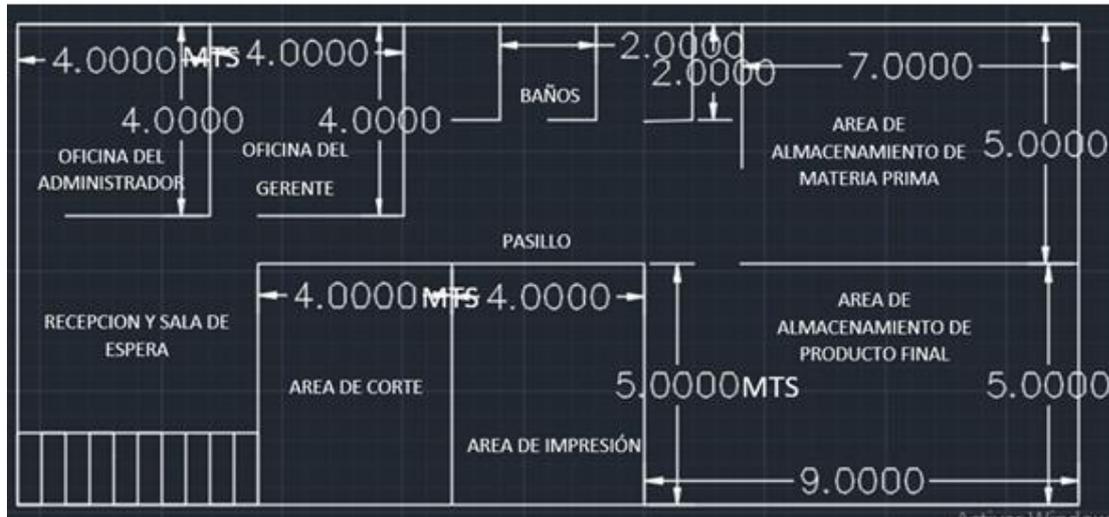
Segunda planta de la empresa Devi Plas. Elaboración propia.
